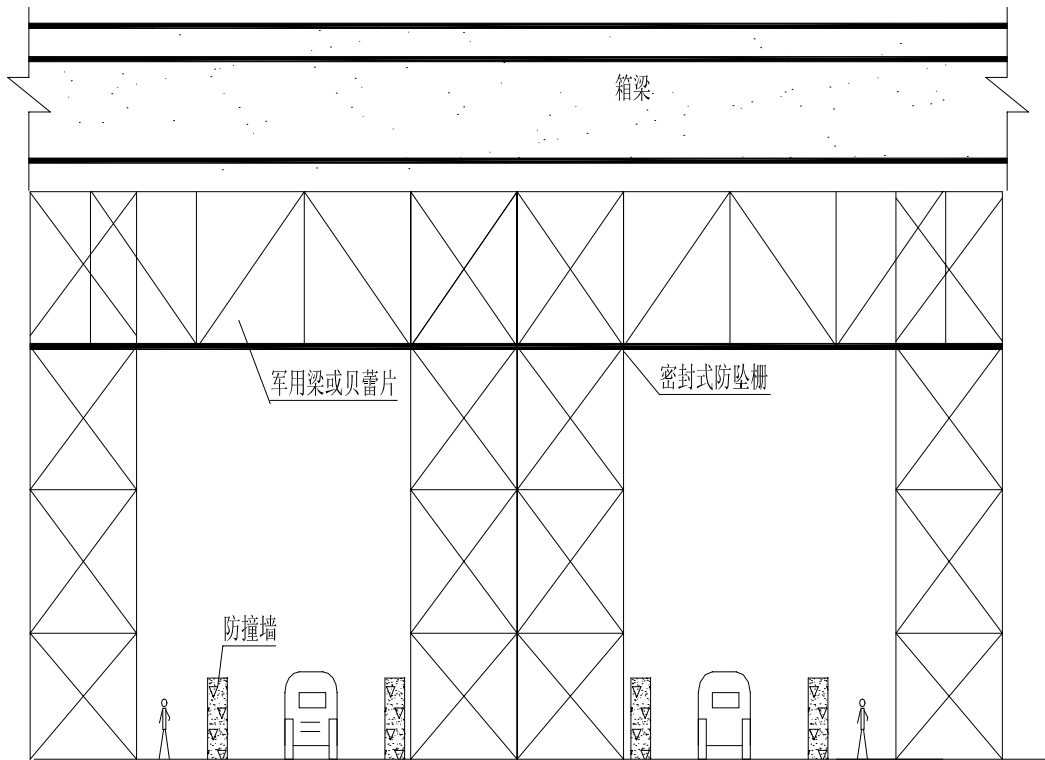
过铁咱人行天桥施工方案纵剖断面图
